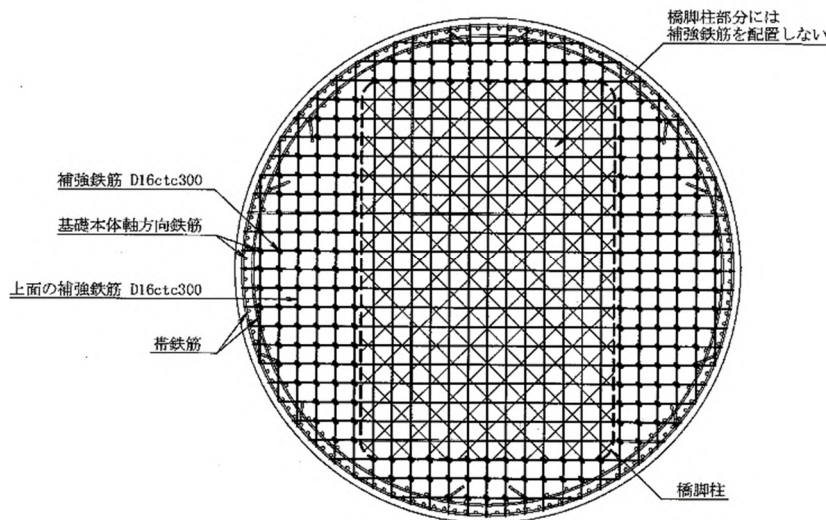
躯体接合部補強鉄筋の平面配置例
